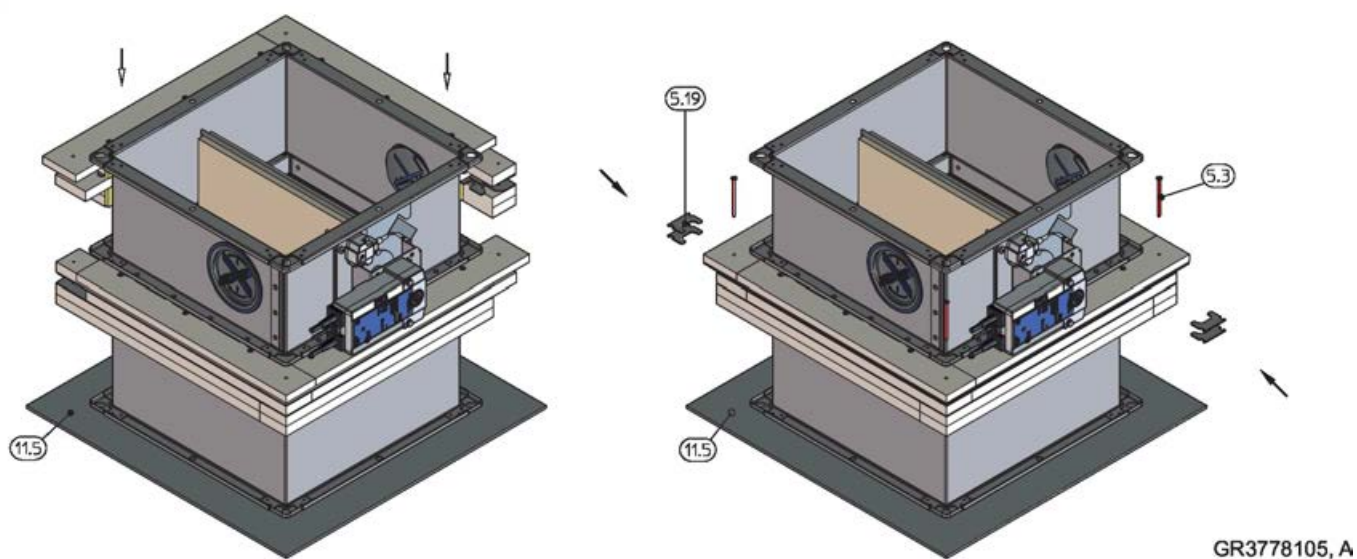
Instalační sada WA pro suchou vestavbu – montáž
